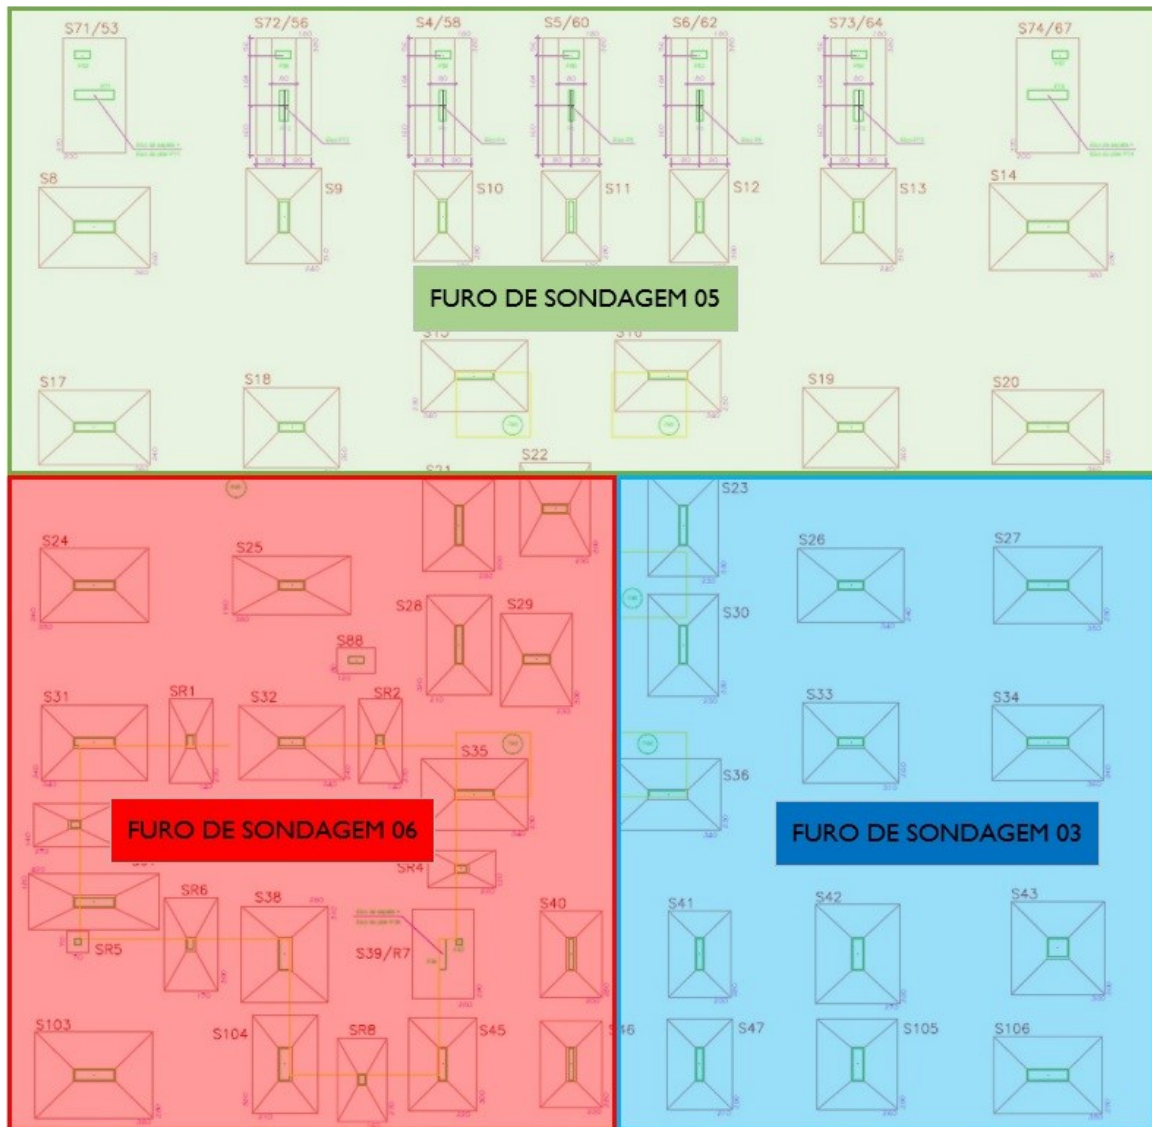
Planta de localização dos furos de sondagem (SPT)
